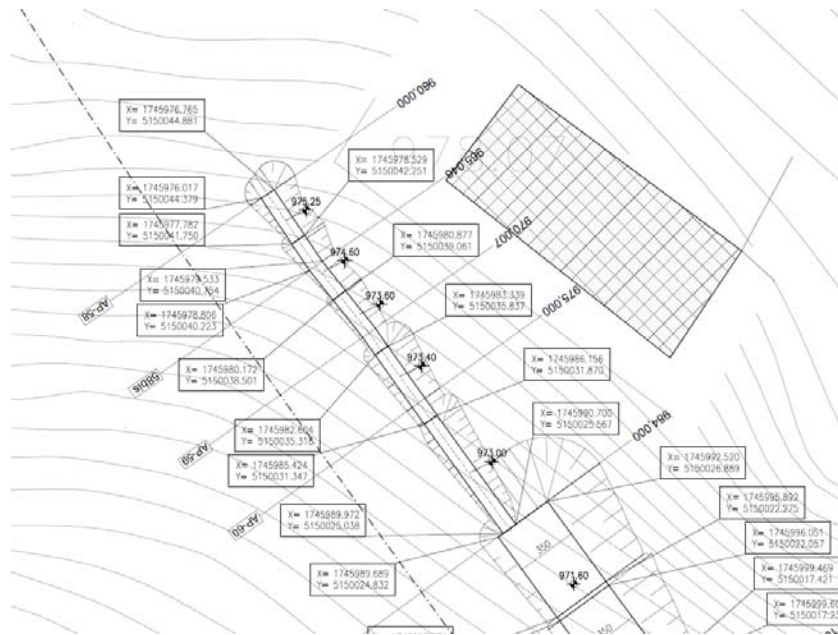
Stralcio della pianta scavi dell'opera OS06 del PE
